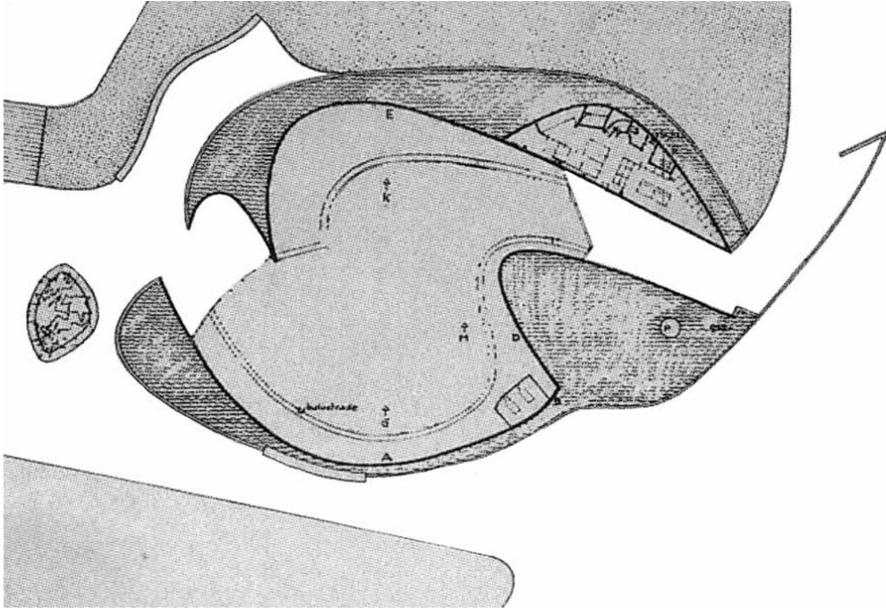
Grundriss mit Kennzeichnung der Sound- und Lichtinstalltionen
